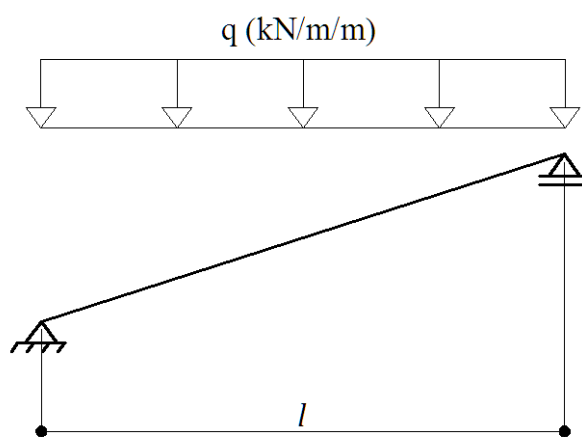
Largura de cálculo de escada armada longitudinalmente
